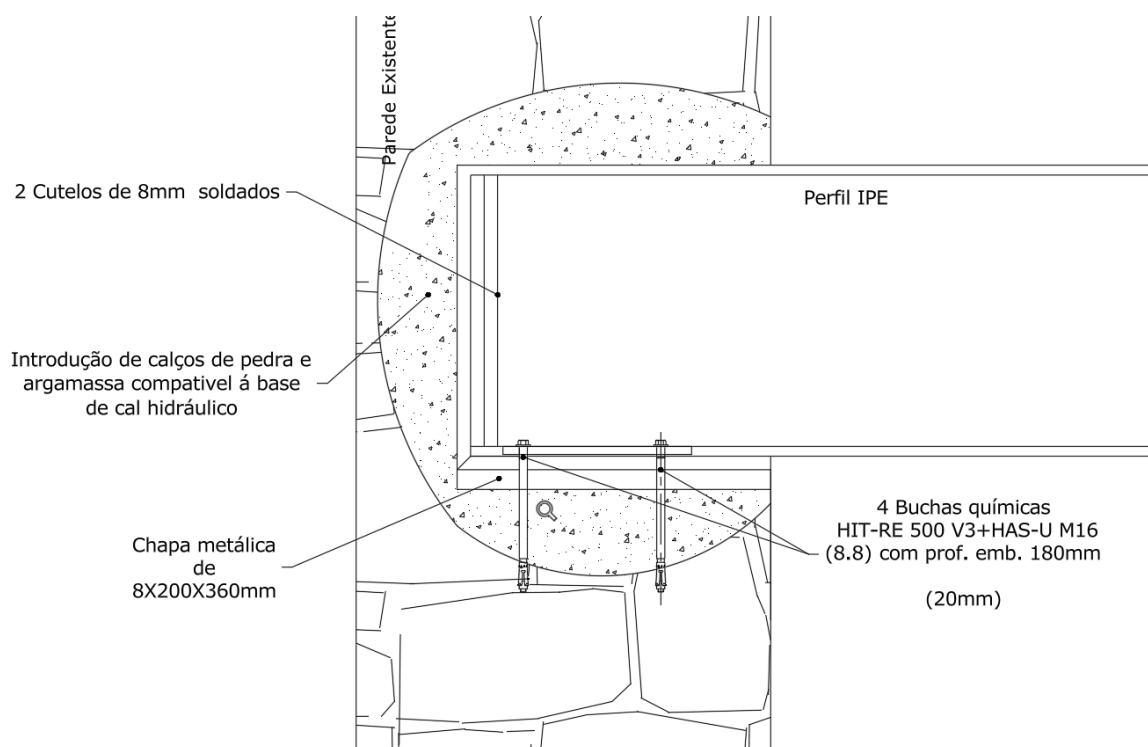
Pormenor da ligação entre os perfis metálicos do pavimento e a parede de alvenaria de pedra.
